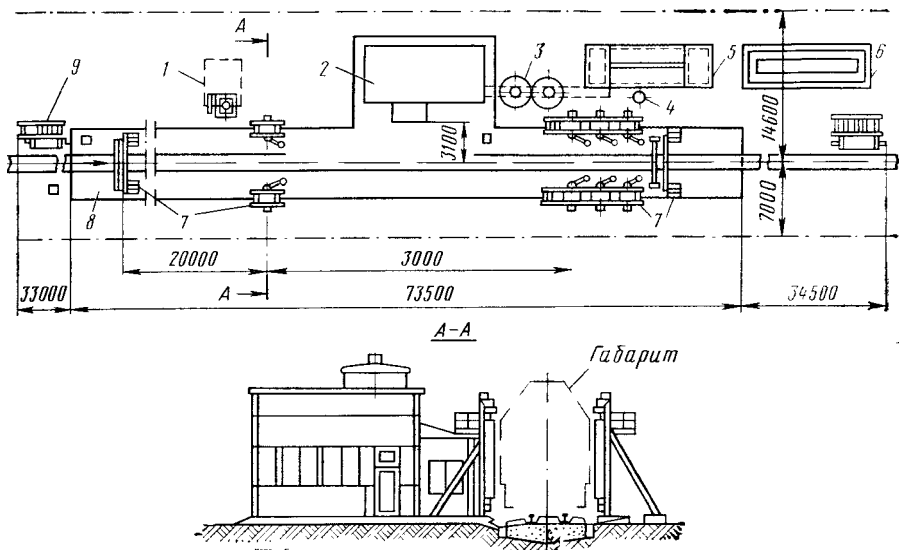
Устройство для обмывки электровозов и тепловозов на открытой площадке:
